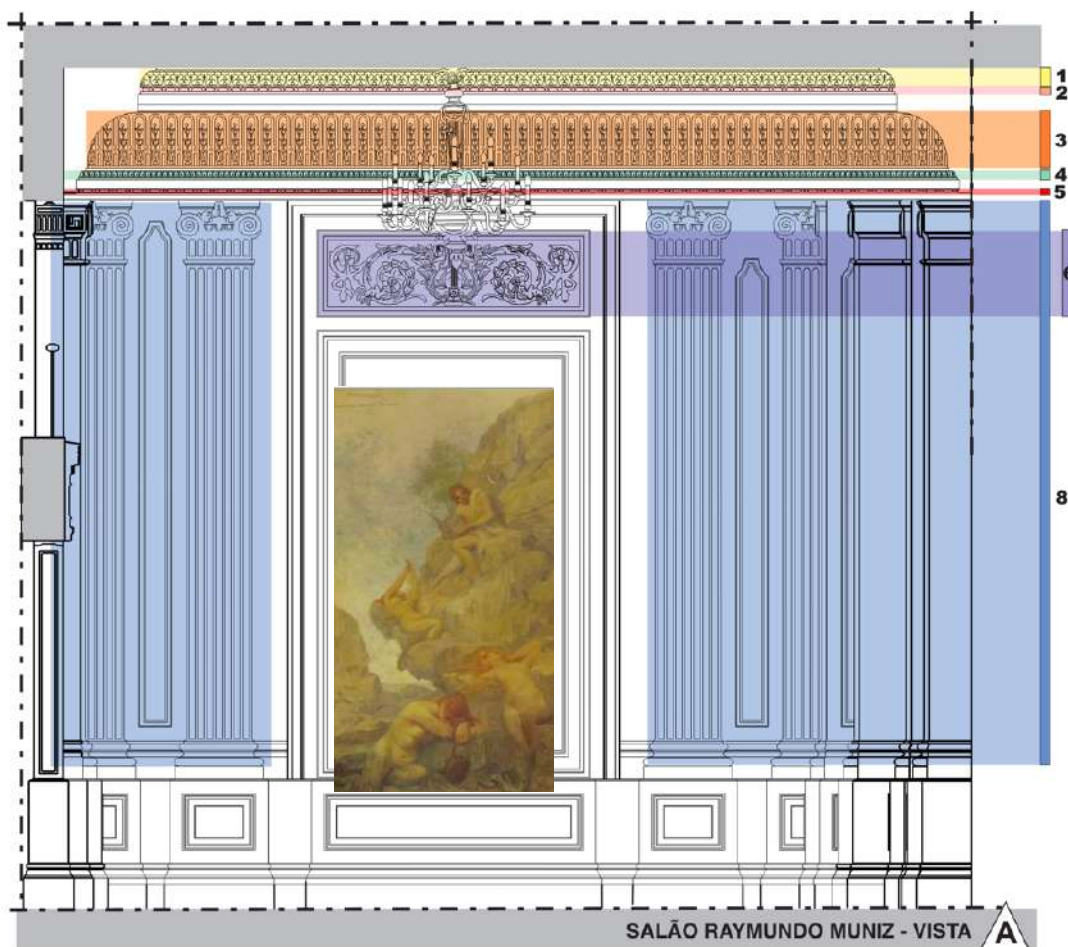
Planta Baixa Salão Raymundo Moniz: VISTAS.
